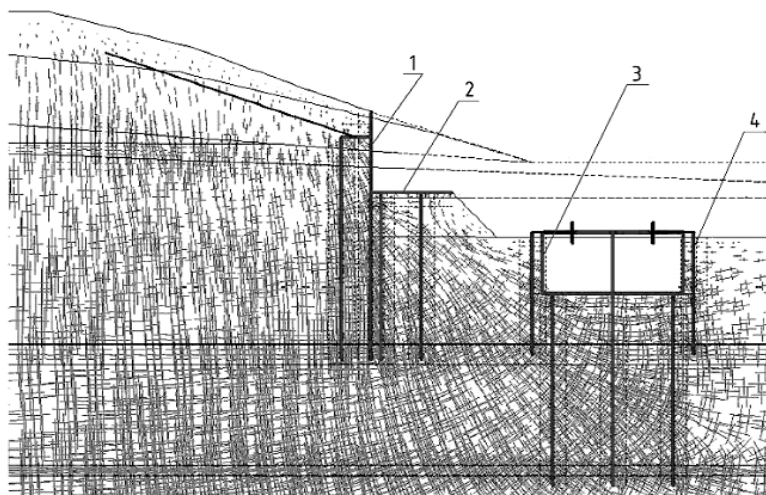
Розрахункова схема з влаштування котловану "холодної зони" зі шпунтовою огорожею і виконання залізобетонних конструкцій всередині котловану до розробки ґрунту під плитою естакади:
